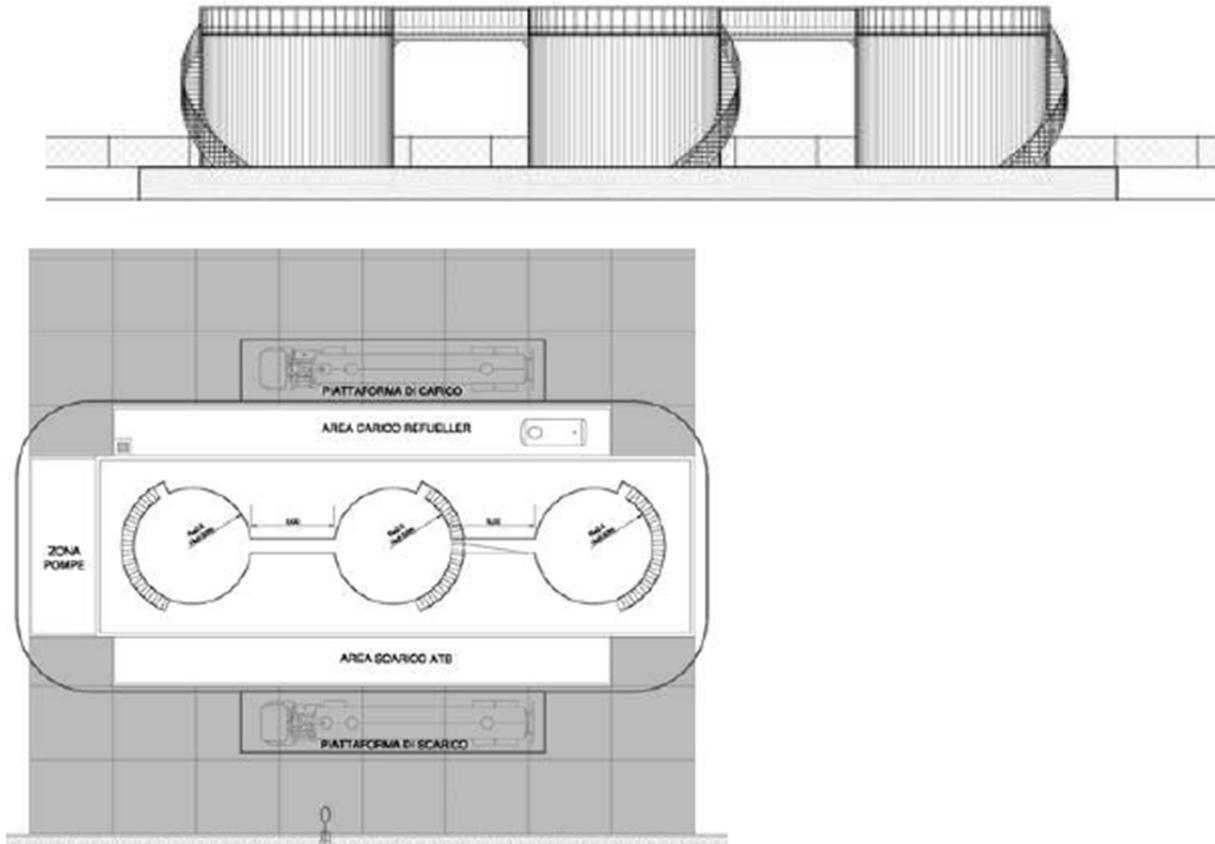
Nuovo deposito carburanti – schema planimetrico e prospettico tipo.
